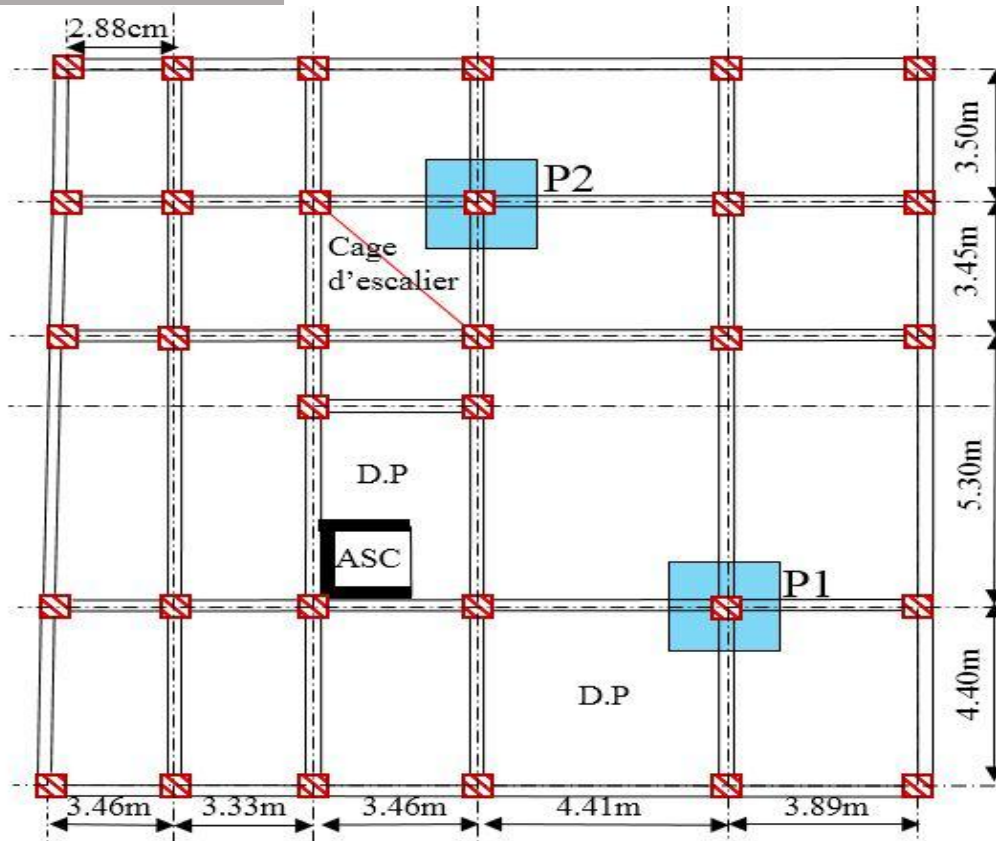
Vue en plan des deux poteaux pour la descente de charges.
